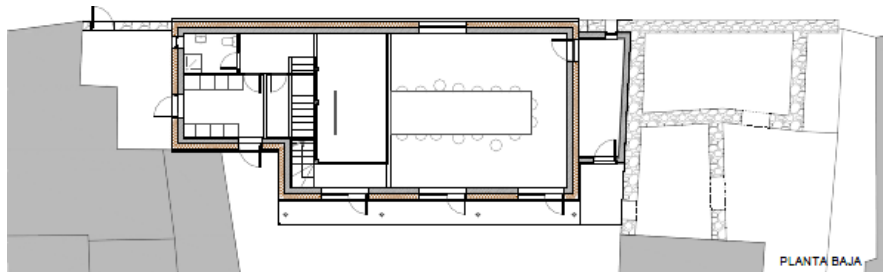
Planta baja de la Casa Taller Laboratorio Passivhaus.
